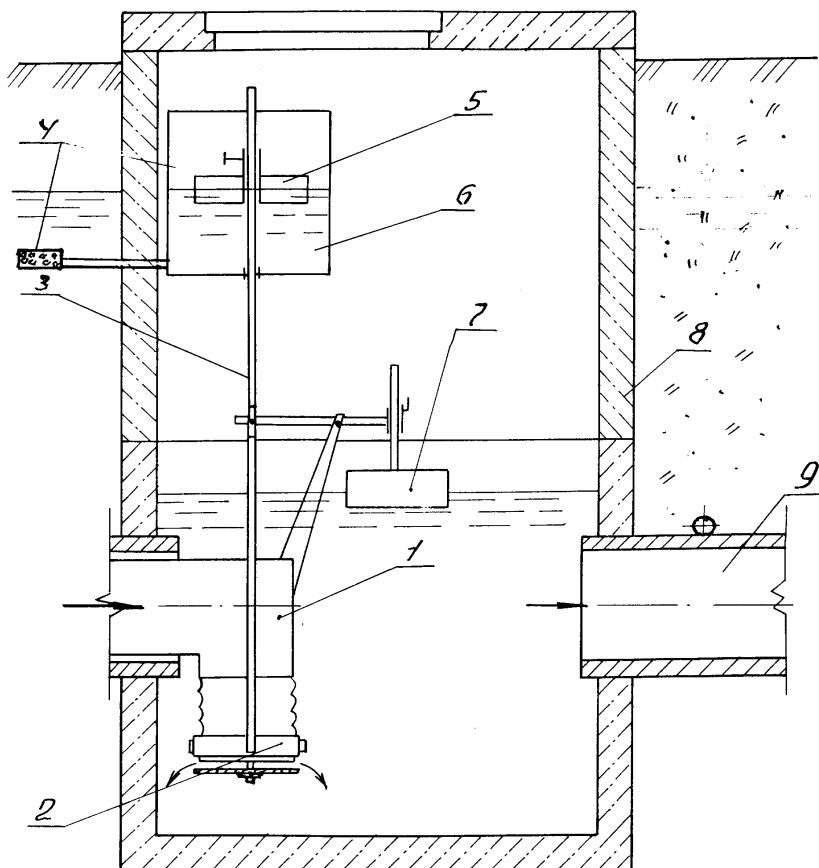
Регулятор дренажного стоку: 1 – корпус; 2 – клапан; 3 – штанга; 4 – фільтр; 5,7 – датчики рівня; 6 – камера; 8 – колодязь; 9 – колектор
